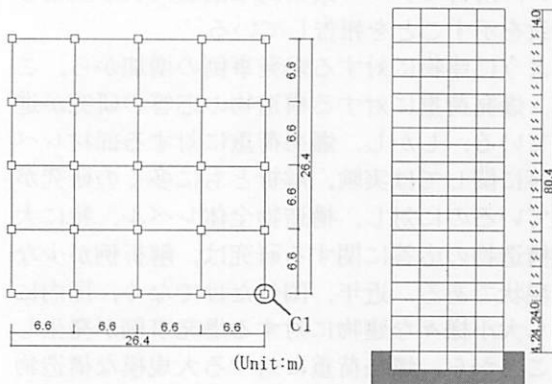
平面図(単位:m) 図-2 軸組図(単位:m)
